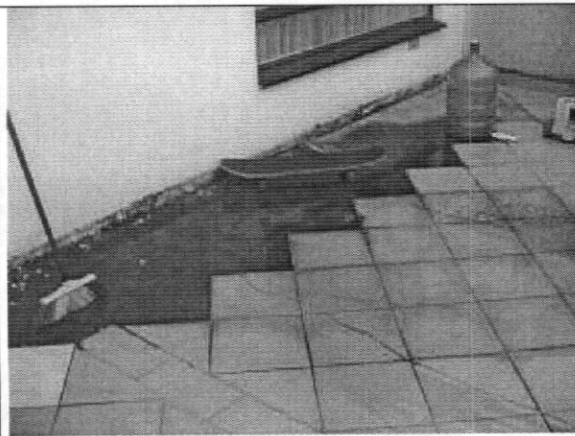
Fisuras en acabados sobre placa de plataforma.
